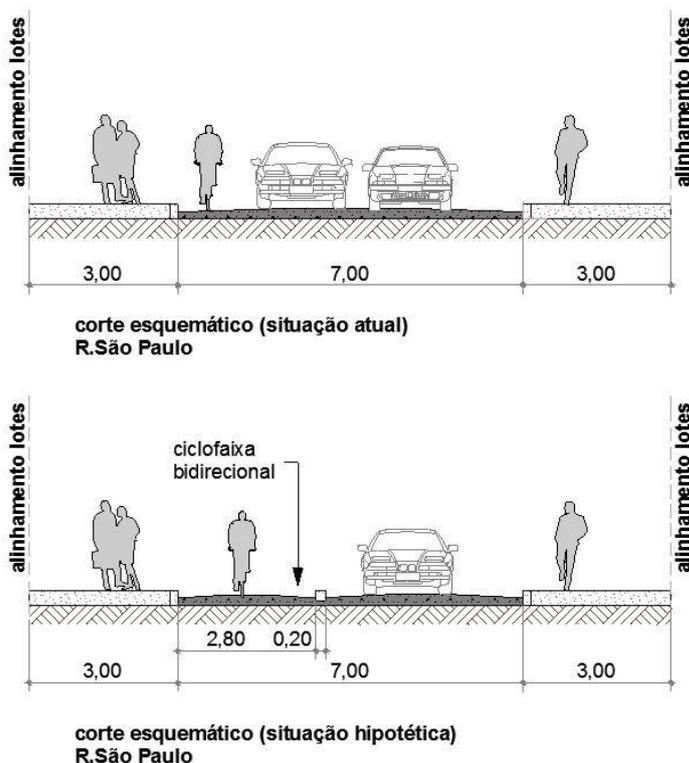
Corte Esquemático R São Paulo, (fonte: autor)
